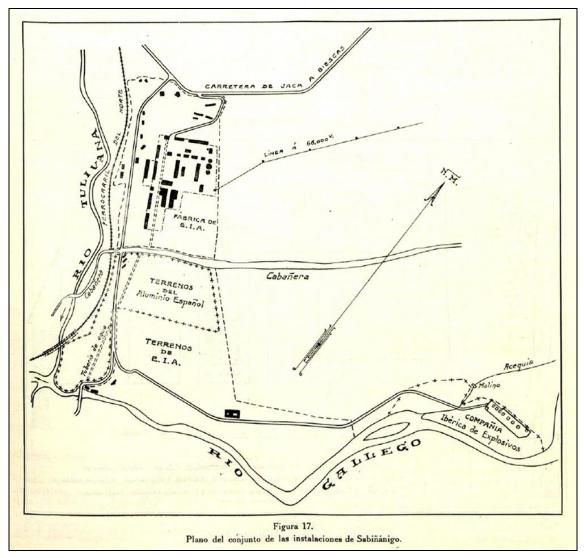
Plano de instalaciones en Sabiñánigo (Ingeniería y Construcción, 1927)
